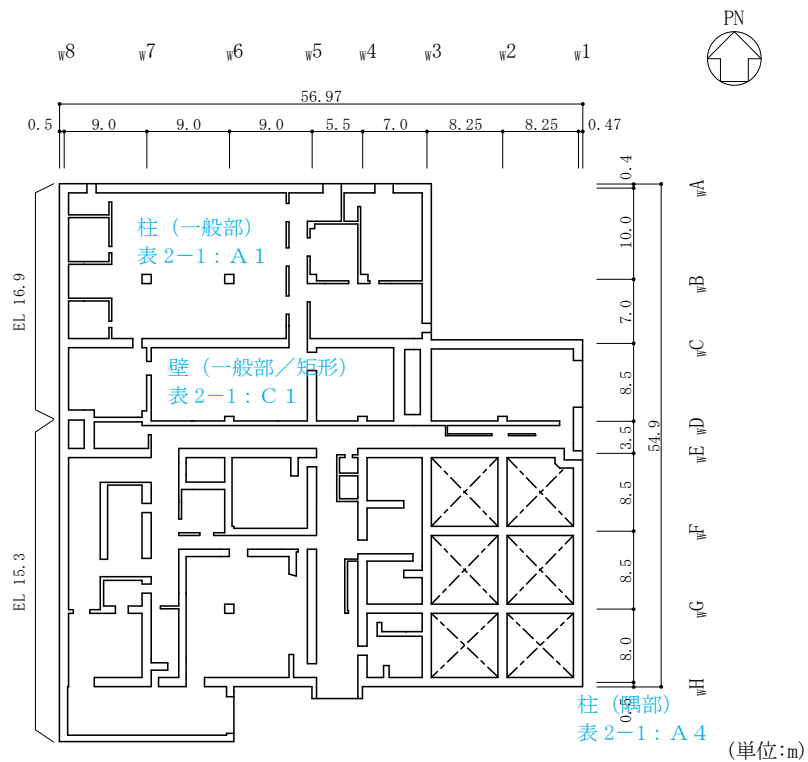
(4) 廃棄物処理建物の概略平面図 (EL 15.3m, EL 16.9m)
